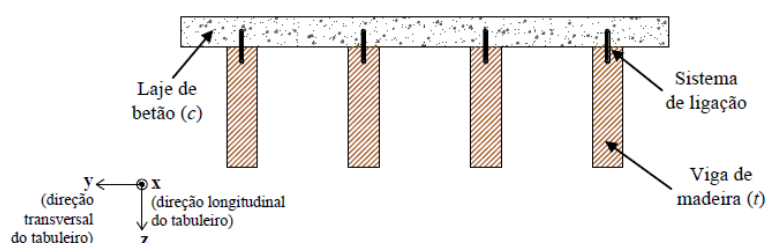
Secção transversal da viga mista madeira-betão (Fonte: Rodrigues,2014).
